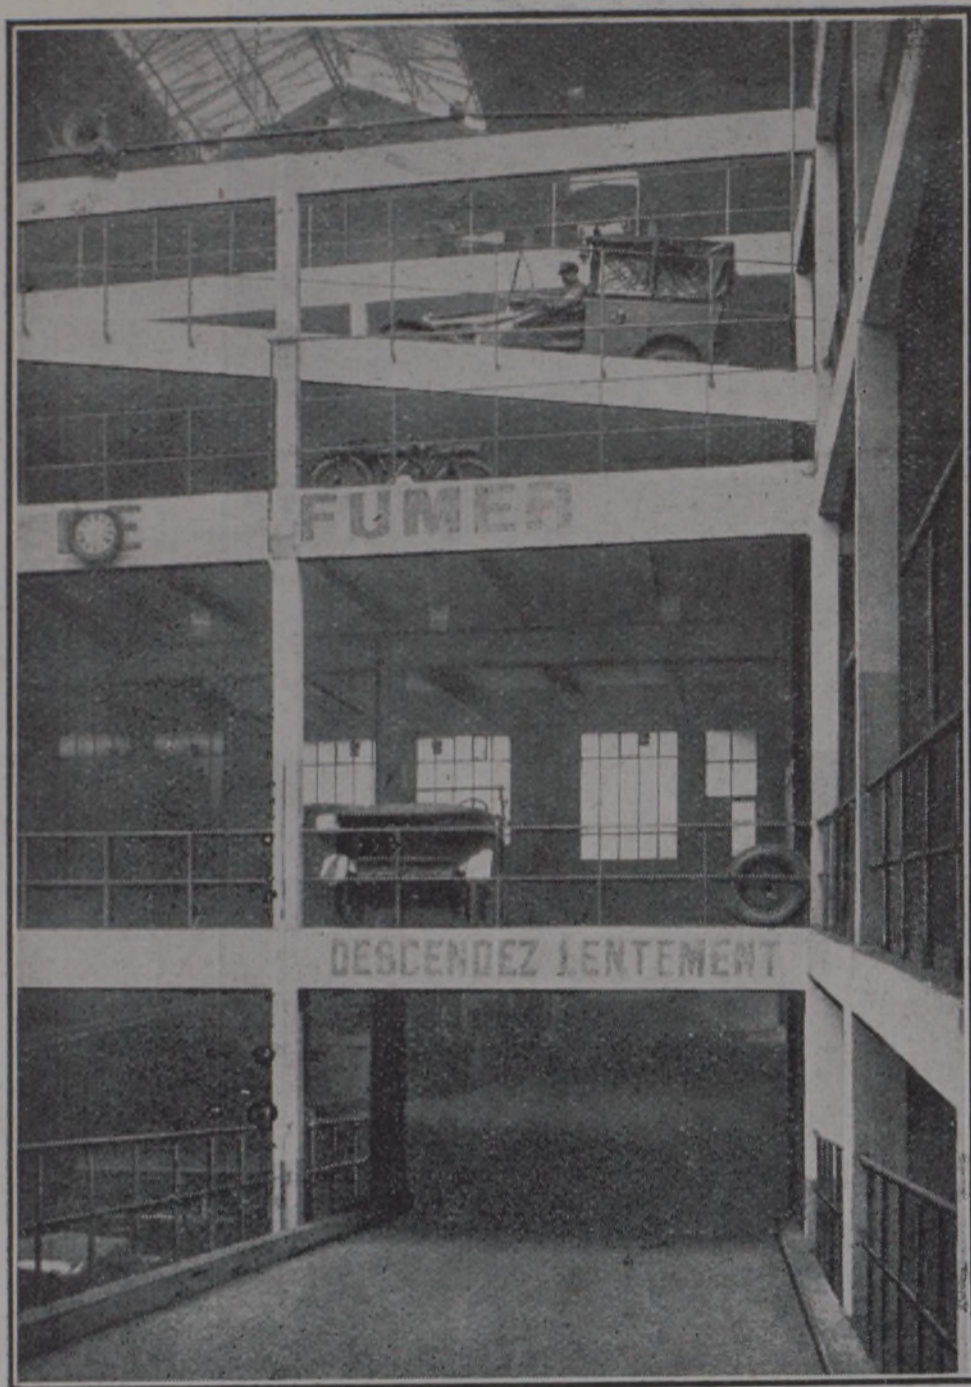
Fig. VI. — AUTRE EXEMPLE DE GARAGE A RAMPES. — Garage de la rue Forest (3 étages). Une rampe droite monte au premier étage puis bifurque pour gagner les deux autres étages.
